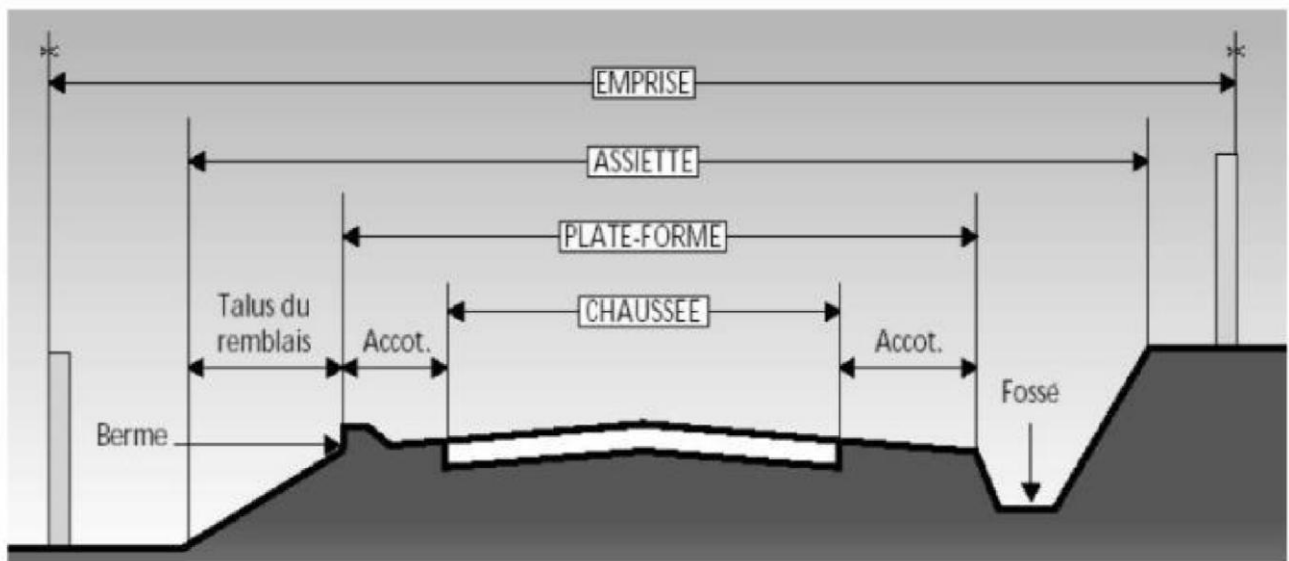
11 Figure Les éléments constitutifs d'une chaussée [17]
